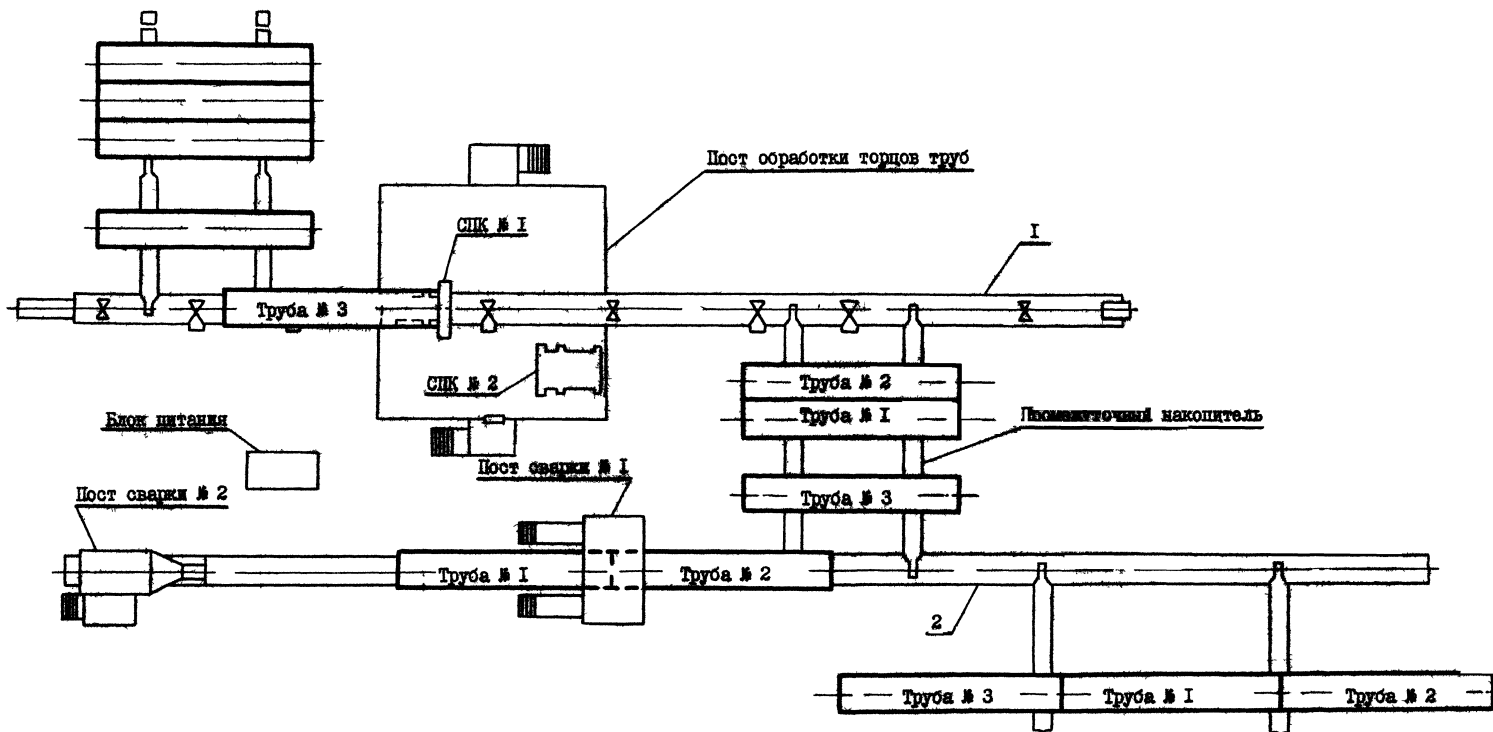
Схема производства работ по сборке и сварке труб в трехтрубные секции на механизированной трубосварочной базе БТС-142В
